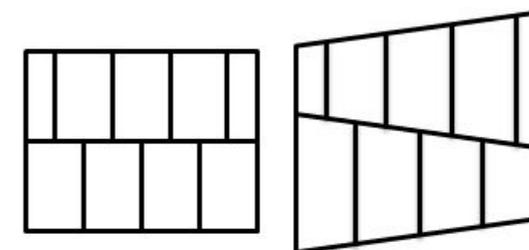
Pianta degli anelli di rivestimento rettangolari e trapezoidali
